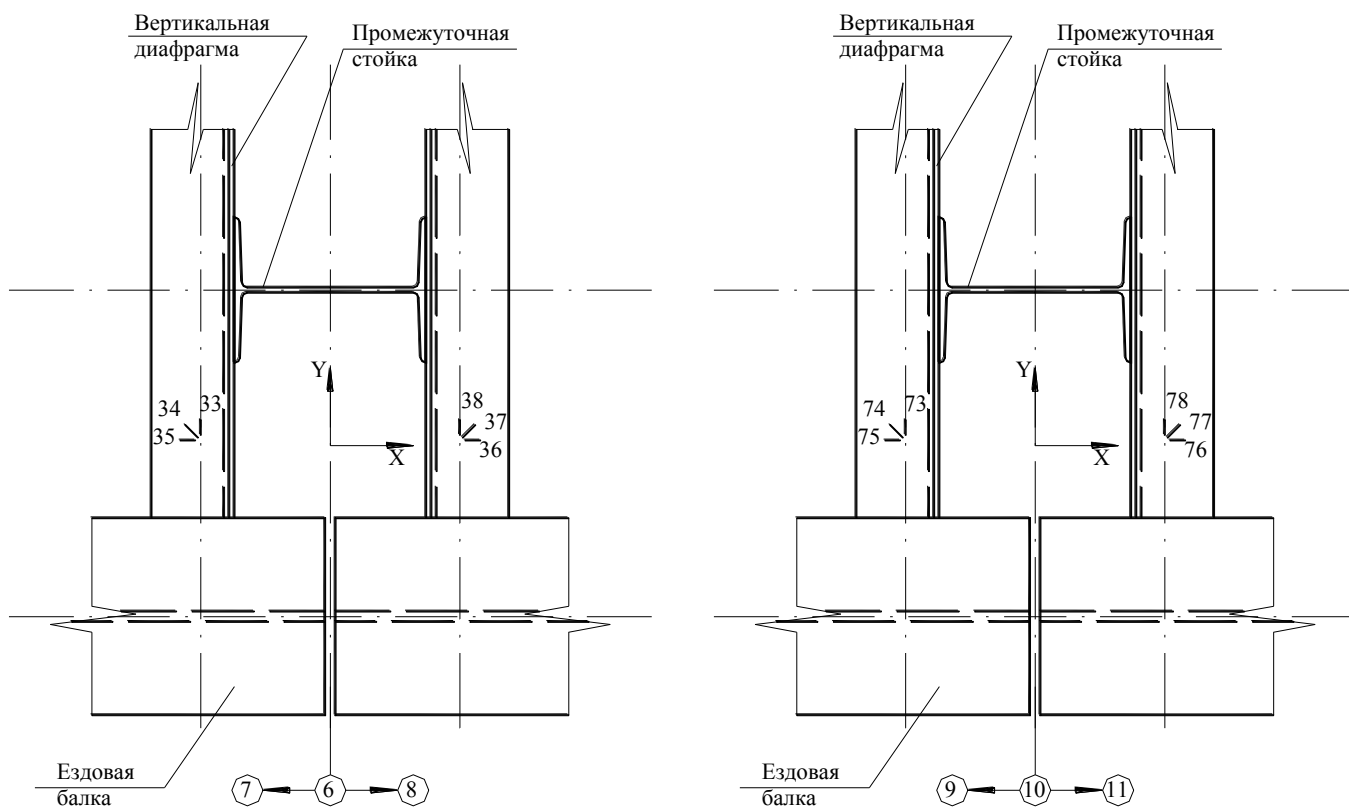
Размещение тензорозеток на уголках узла крепления ездовой балки мостового перегружателя №2 КХП ОАО «ММК»
